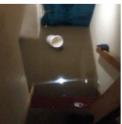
Planta inferior inundable (Homeowners guide to flood resilience)
